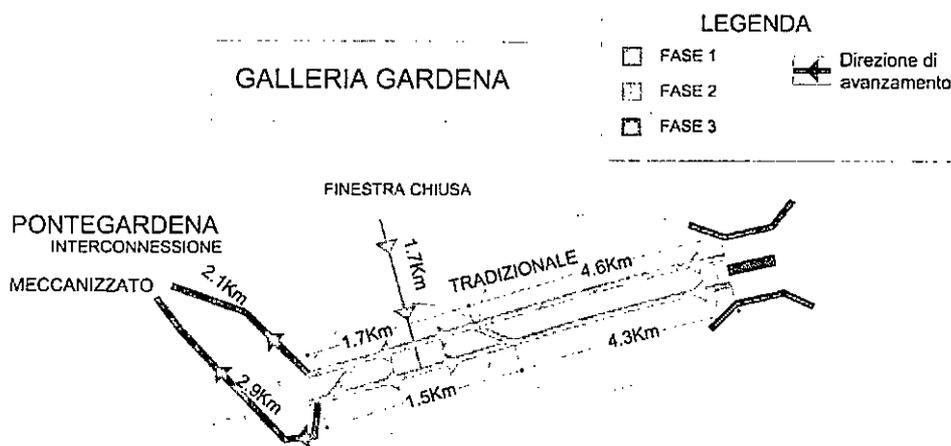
Modalità di scavo Galleria Gardena Lotto 1 Fortezza - Ponte Gardena
